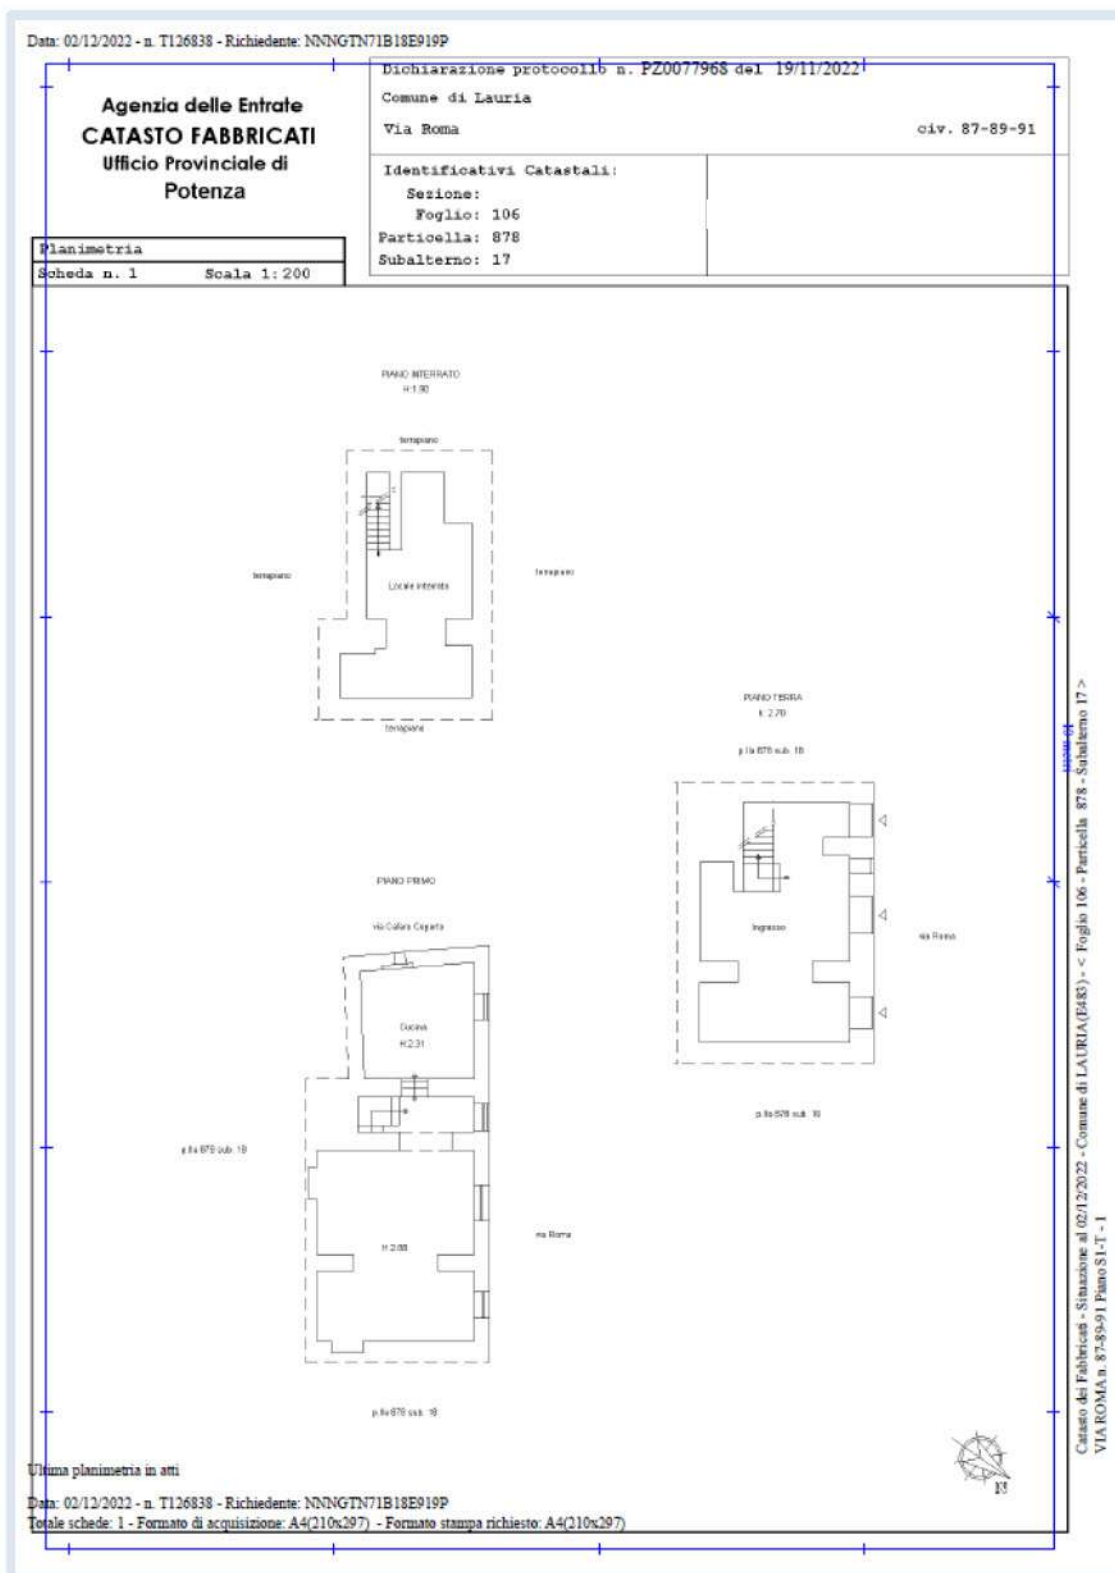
Planimetria “aggiornata” Unità Fg. 106 P.Ila 878 sub. 17
